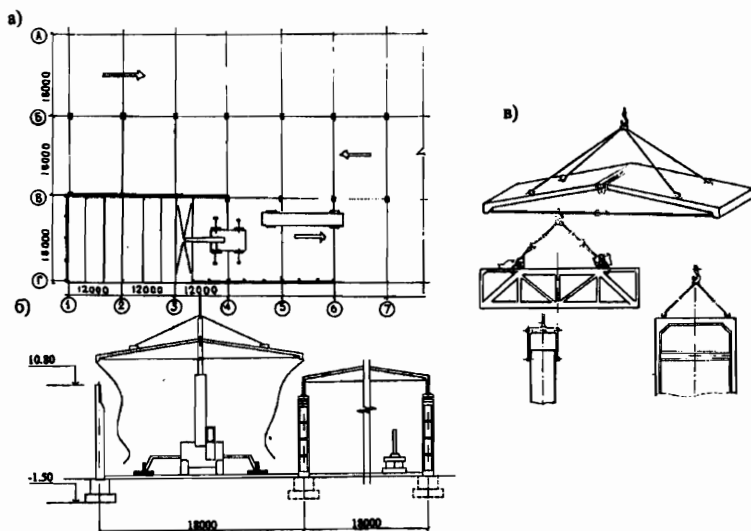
Технологическая схема монтажа 3-пролетного здания: а - технологическая последовательность монтажа элементов БМЗ; б - монтаж панелей покрытия; в - схемы строповки сборных элементов быстромонтируемого здания
